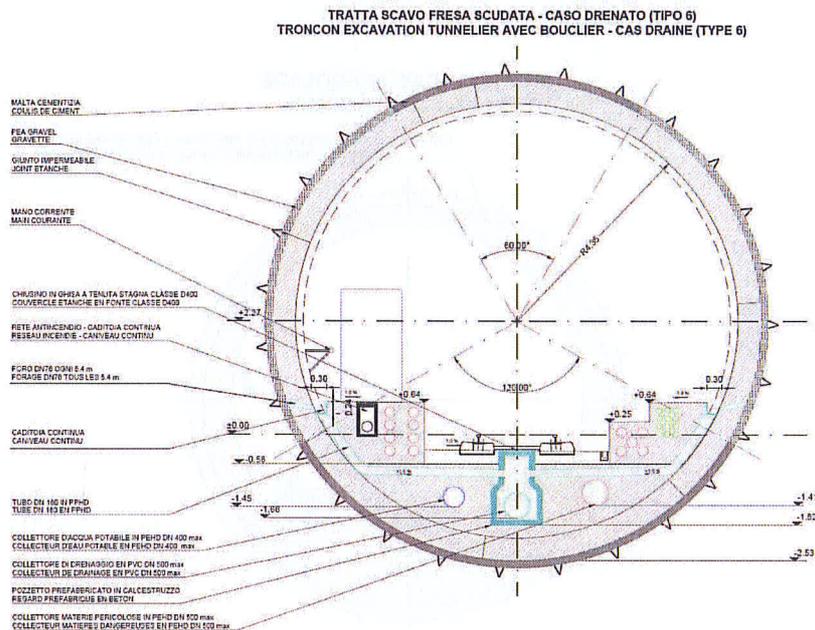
Impermeabilizzazione di tipo 6 per scavo con TBM scudata
